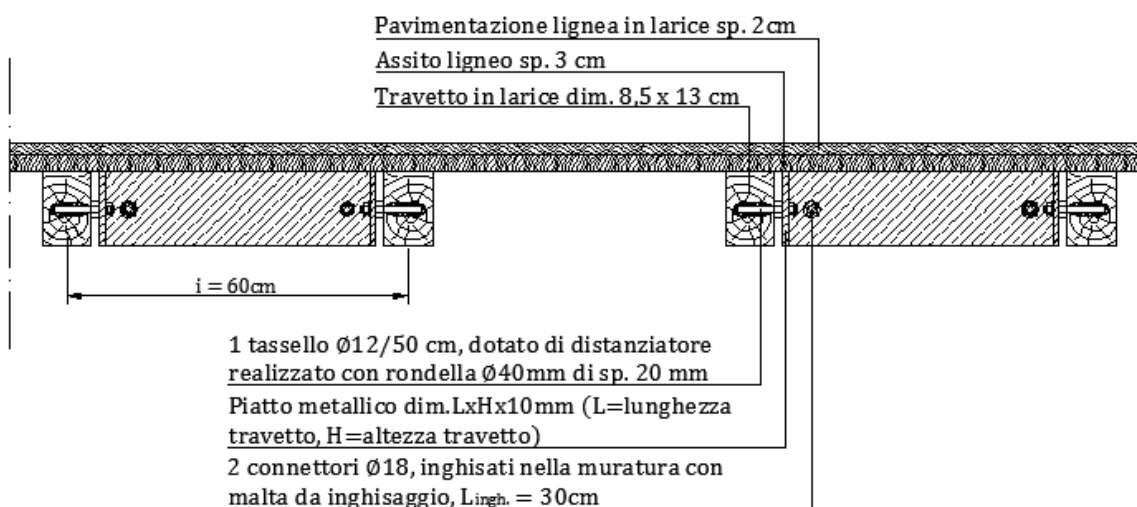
Sezione trasversale del solaio rinforzato con casseri metallici
